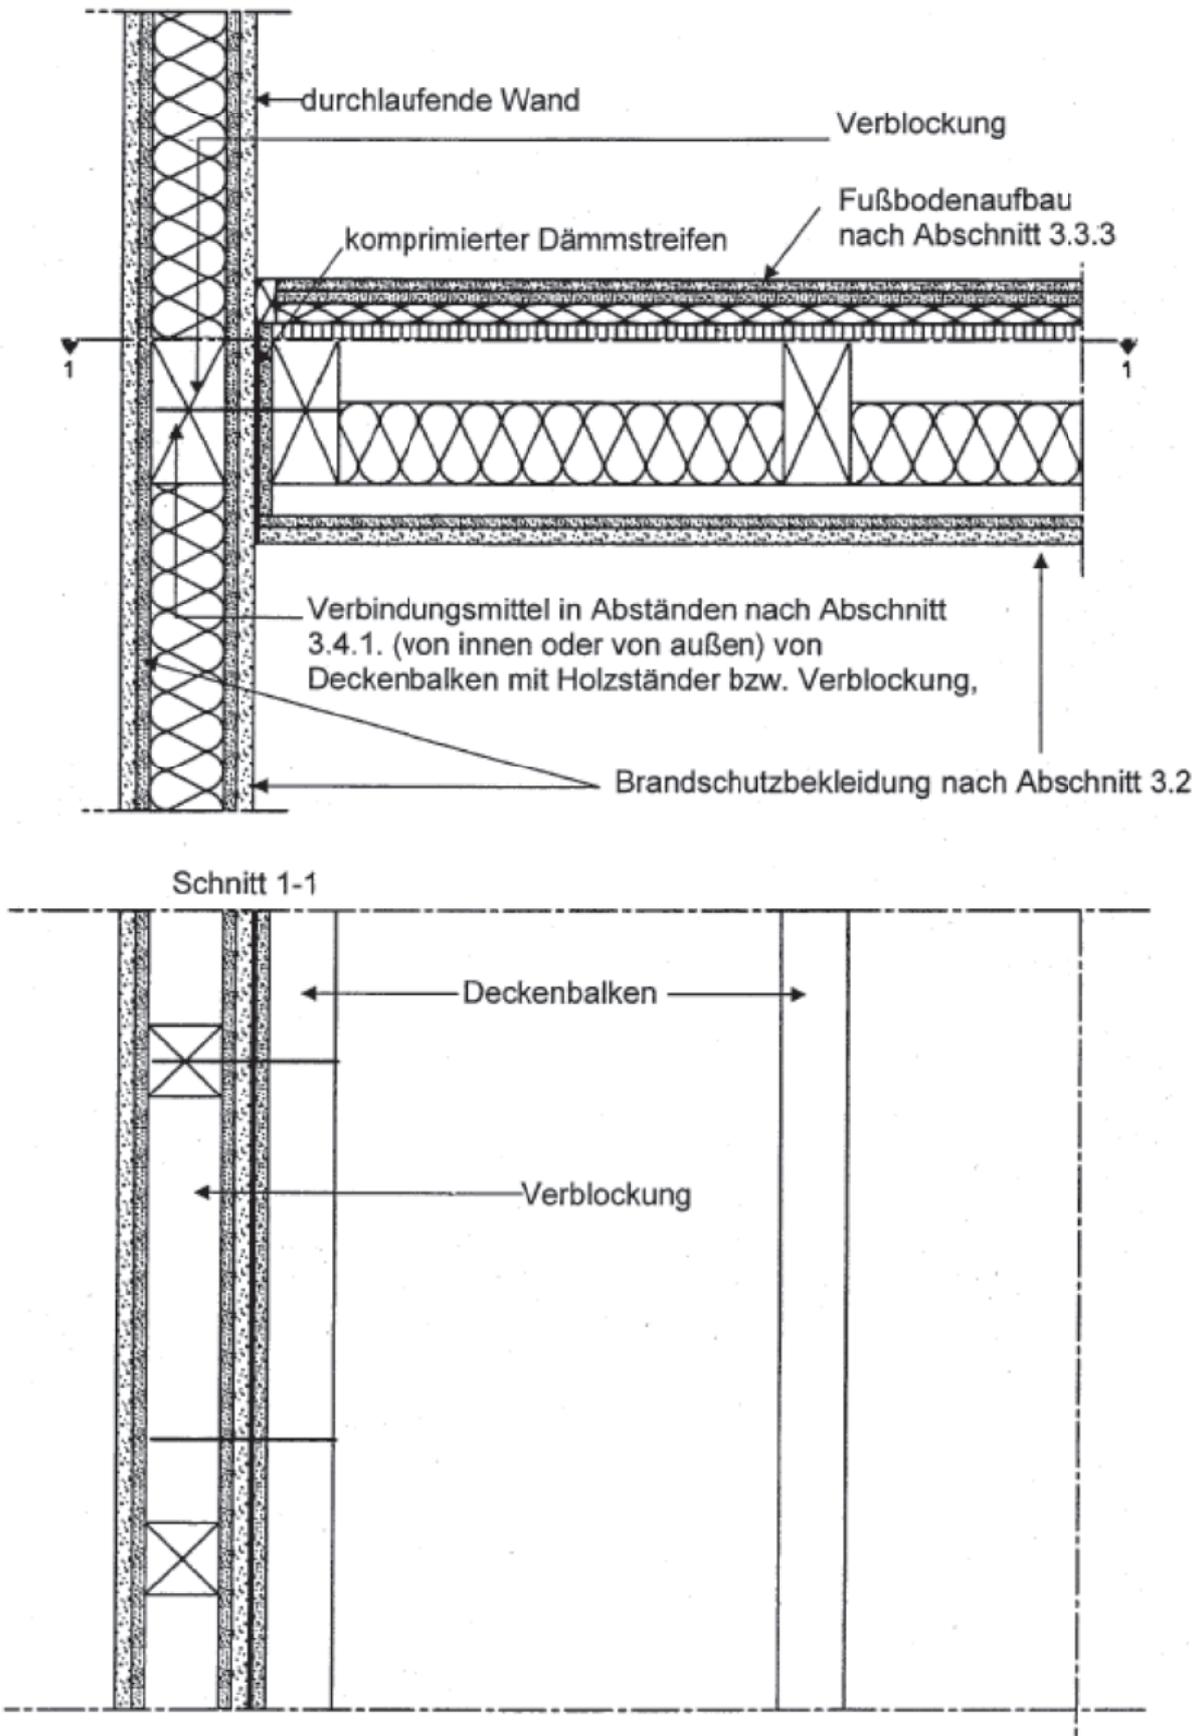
Anschluss Decke nach Abschn. 3.3.3 an durchlaufende raumabschließende Wand nach Abschn. 3.3.2 (Treppenraumwand, Außenwand, auch nichttragend – Spannrichtung der Deckenbalken parallel zur Wand)
